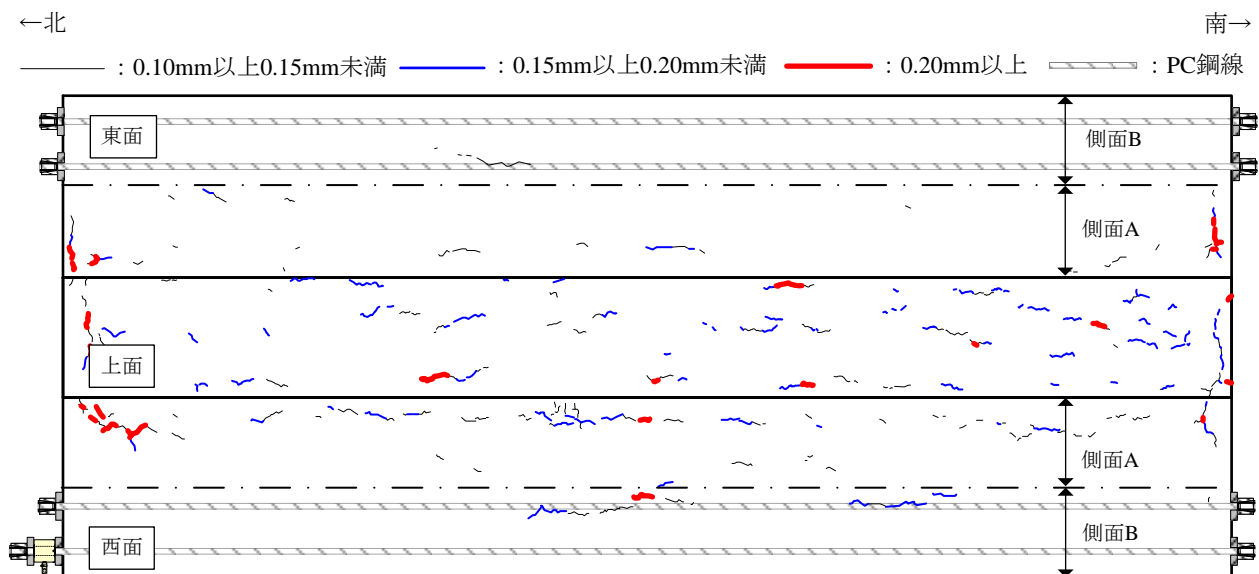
暴露後13ヶ月におけるひび割れ状況
